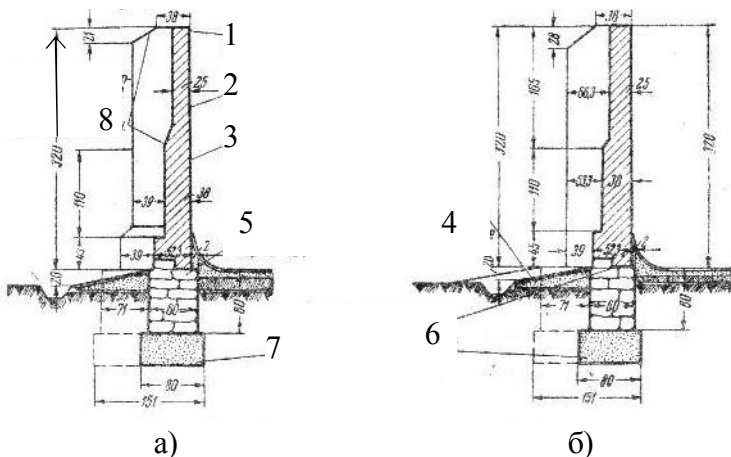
Перетин стін та фундаменту зерноскладу а) між воротами і б) біля воріт: 1 – верхня частина стіни для закладення анкеру кріплення обв'язки; 2 – цегляна стіна з цементом М-10; 3 – штукатурка внутрішньої поверхні стіни; 4 – підмостка з щебеню покрита шаром асфальту; 5 – бутовий фундамент на цементі М-10; 6 – ізоляційний шар; 7 – піщана подушка; 8 – покриття із цементу 1:2 чи крівельної бляхи.
